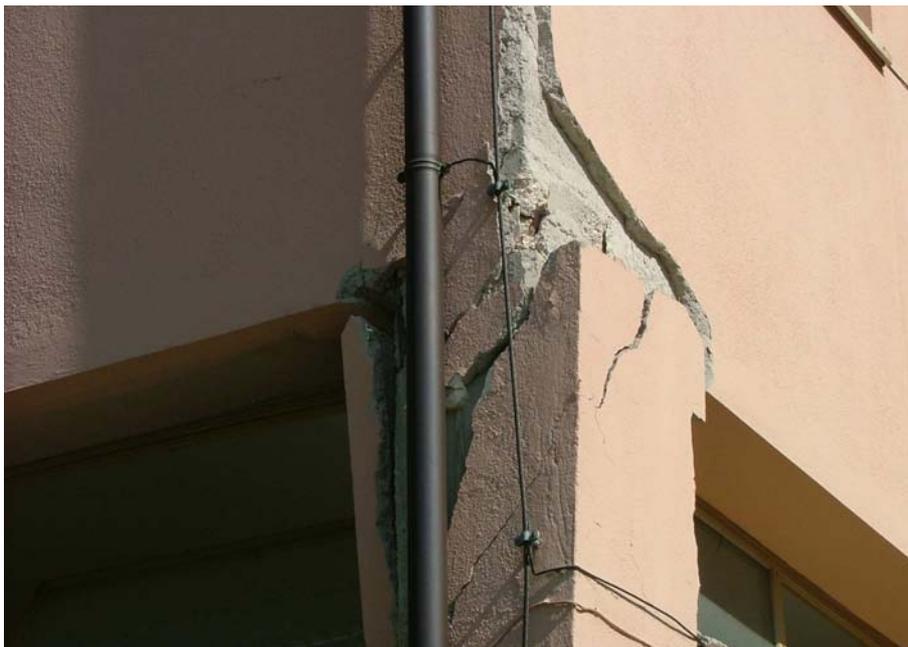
4: Particolare della lesione sul pilastro d'angolo.
